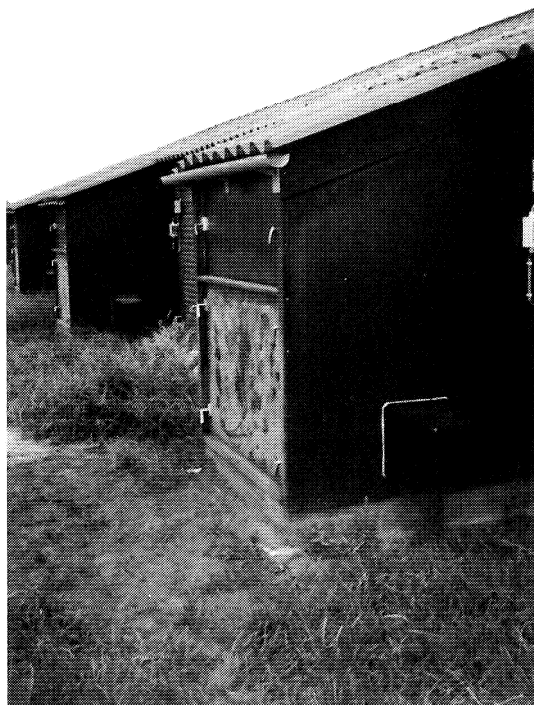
De stoffilterkast met de uitbouw voor de centrifugaalventilatoren.
